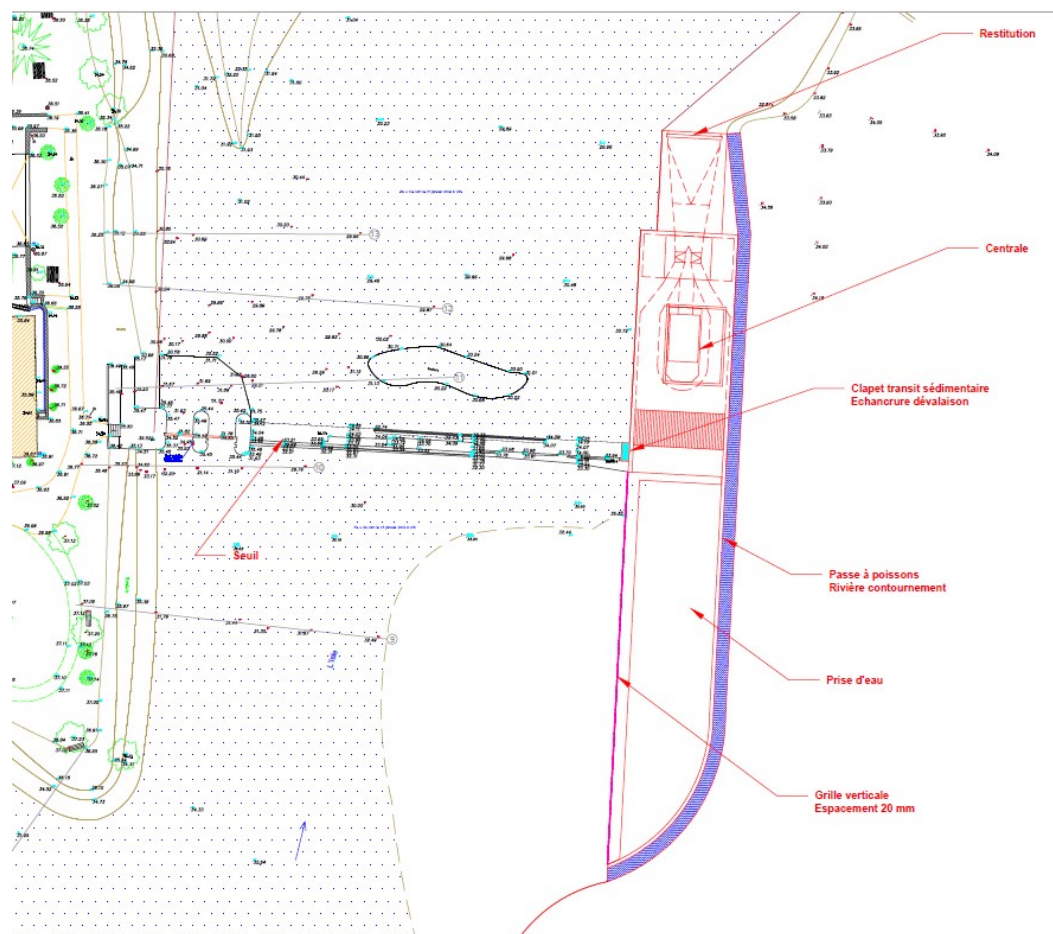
IMPLANTATION DE LA CENTRALE AU NIVEAU DU BARRAGE AVEC LES OUVRAGES DE MONTAISON ET DEVALAISON PISCICOLES (EXTRAIT PLAN 5 PICEE 8)
